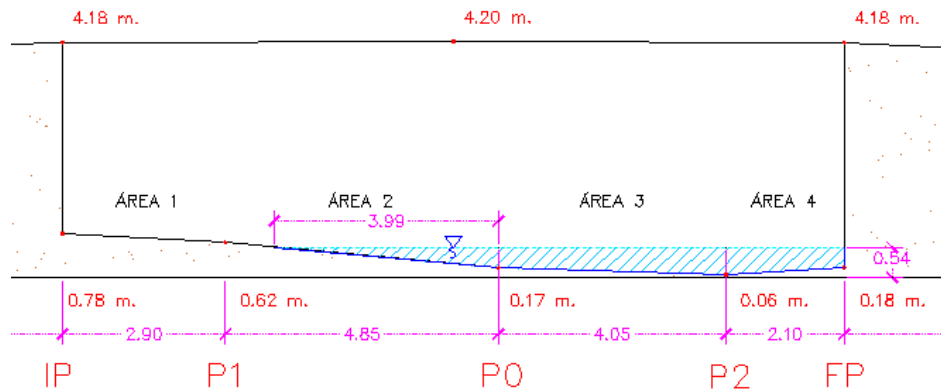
Sección transversal del canal El Macho BM. Ubicación: 10 de Agosto
